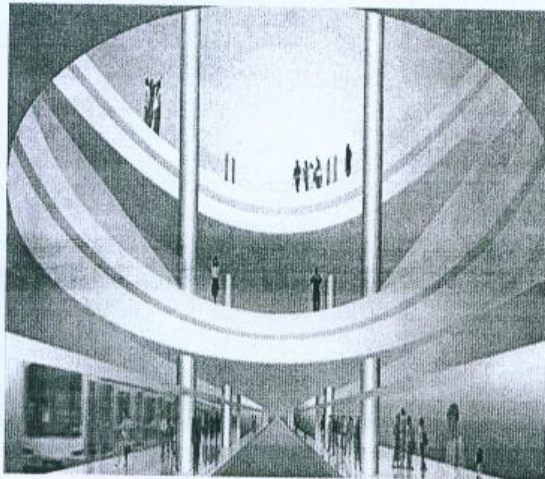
Tiga dimensi bangunan dan struktur yang terlihat kesan taman sebagai eco building dan kejujuran dari system struktur cord an plat slab (area intermadite)
